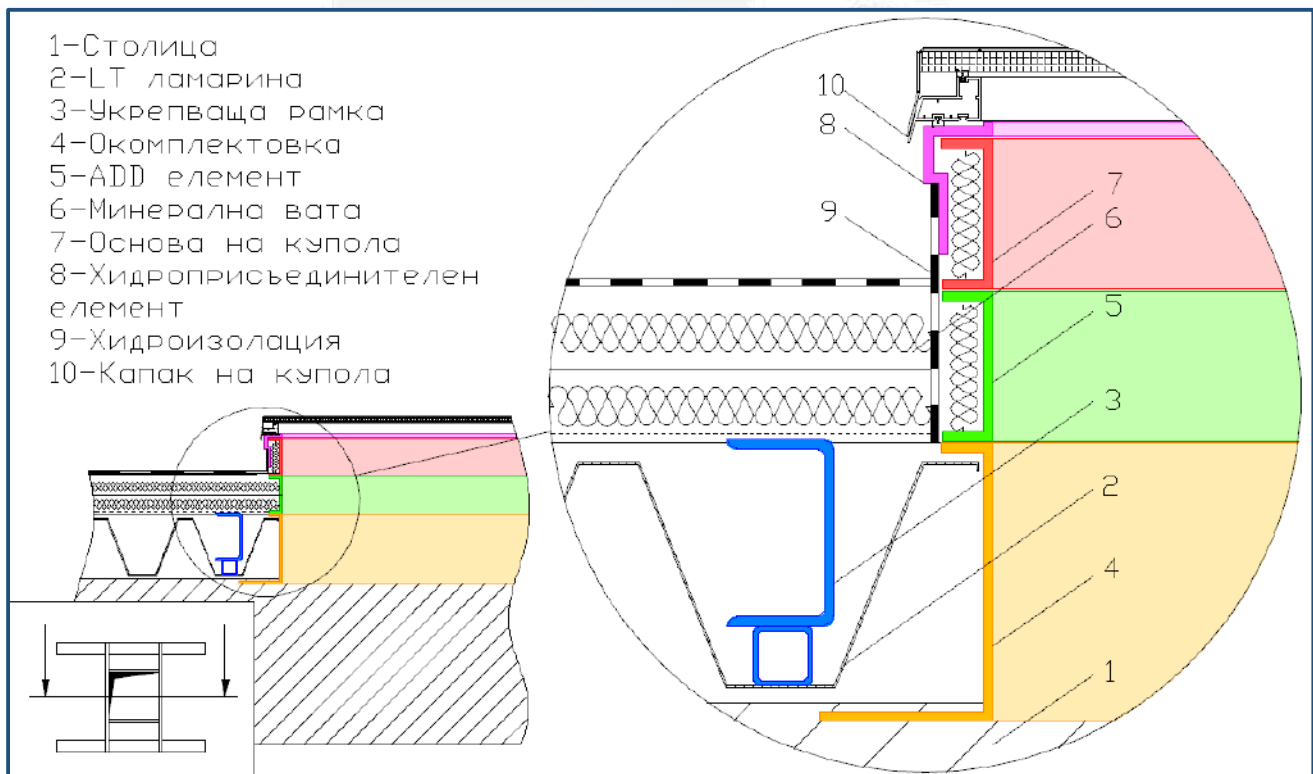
Инсталационна схема №2 - послоен монтаж
